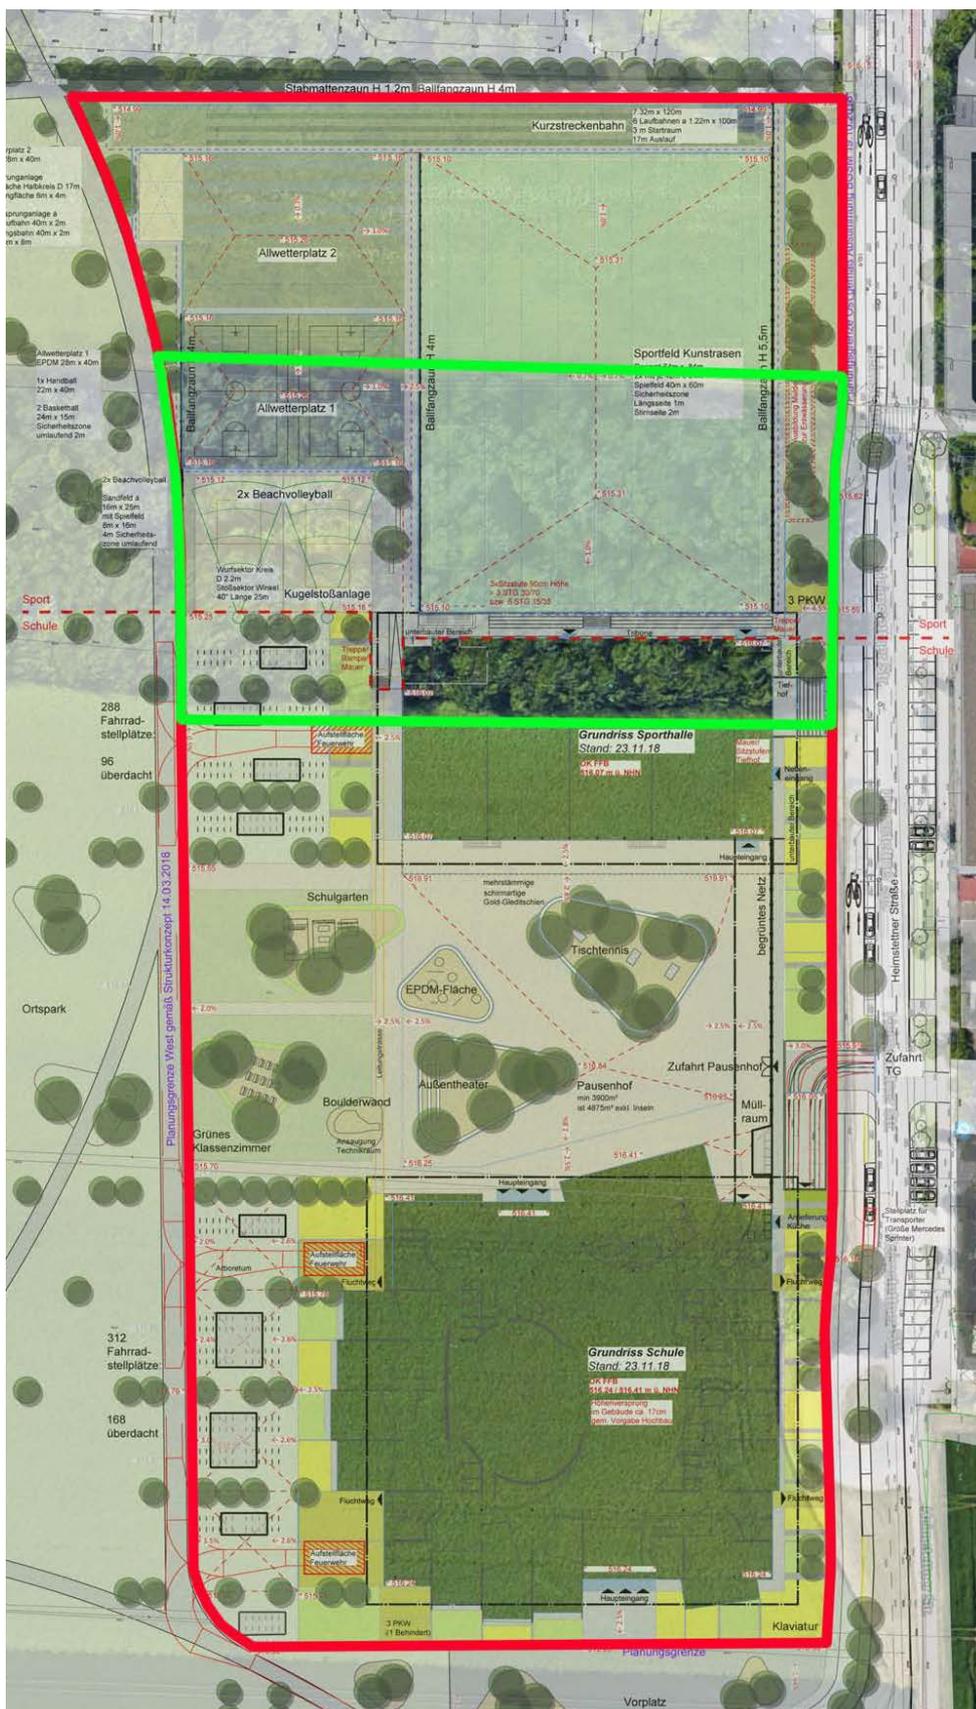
Überlagerung Luftbild und Planung Vorprojekt Stand 30.11.18
